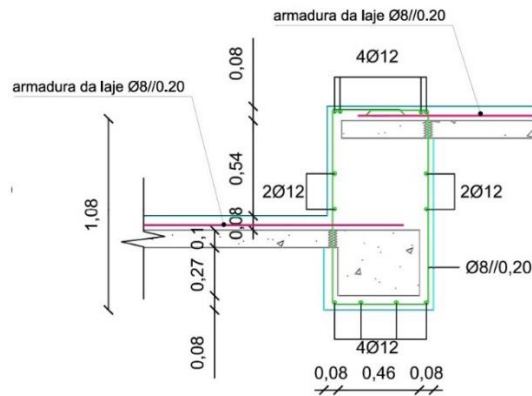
Pormenor da armadura na transição de entre a laje do piso 0 e a laje da galeria
